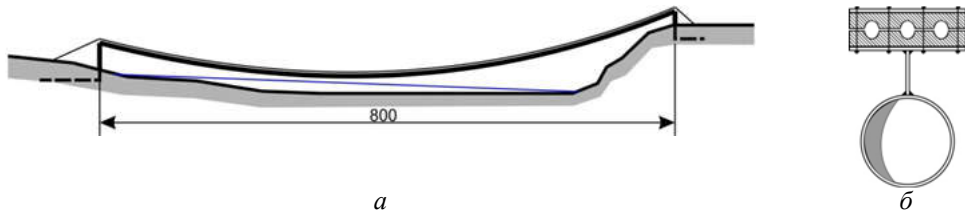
Переход через р. Сырдарья: а – схема, б – поперечный разрез
